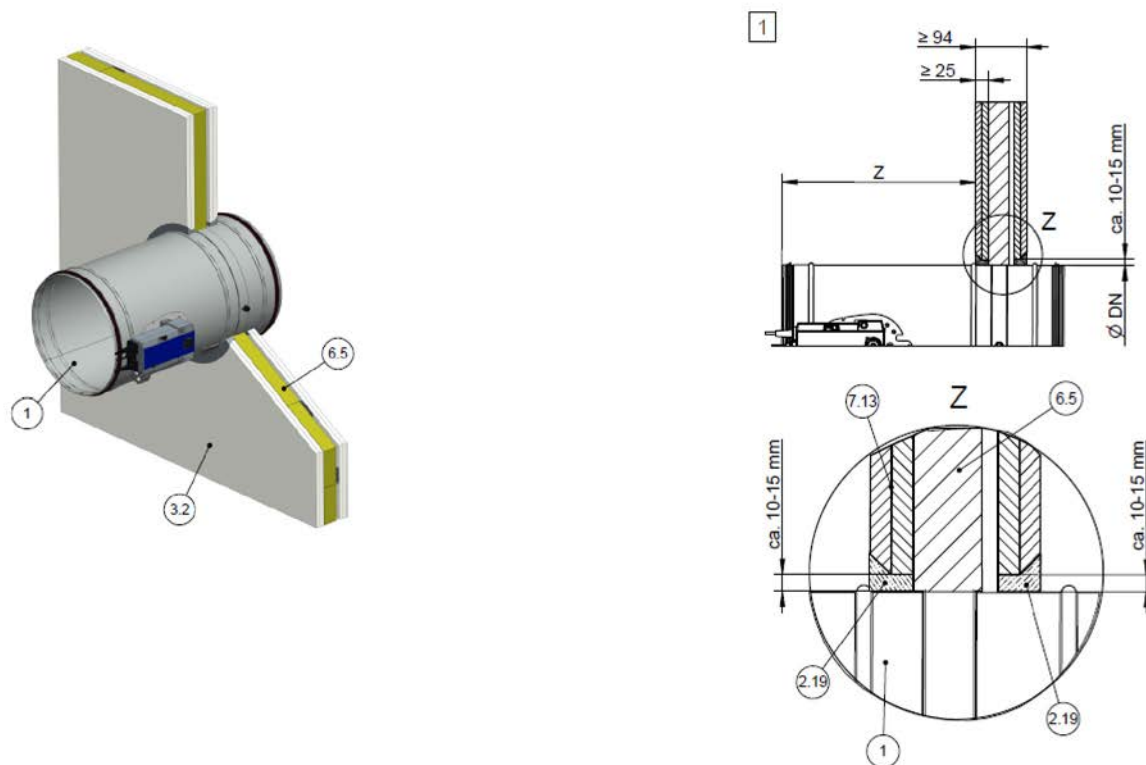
Tørr mørtelfri montasje i en lett skillevegg, uten montasjesett
